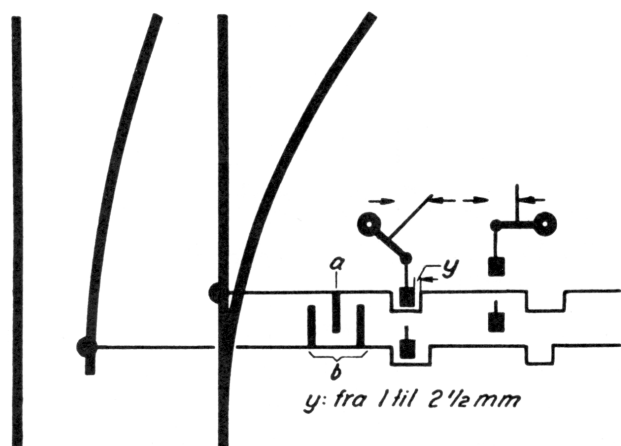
Skematisk fremstilling af kontrolrigler. a er medbringerknasten, b er førerillen. y angiver indreguleringsmål.
